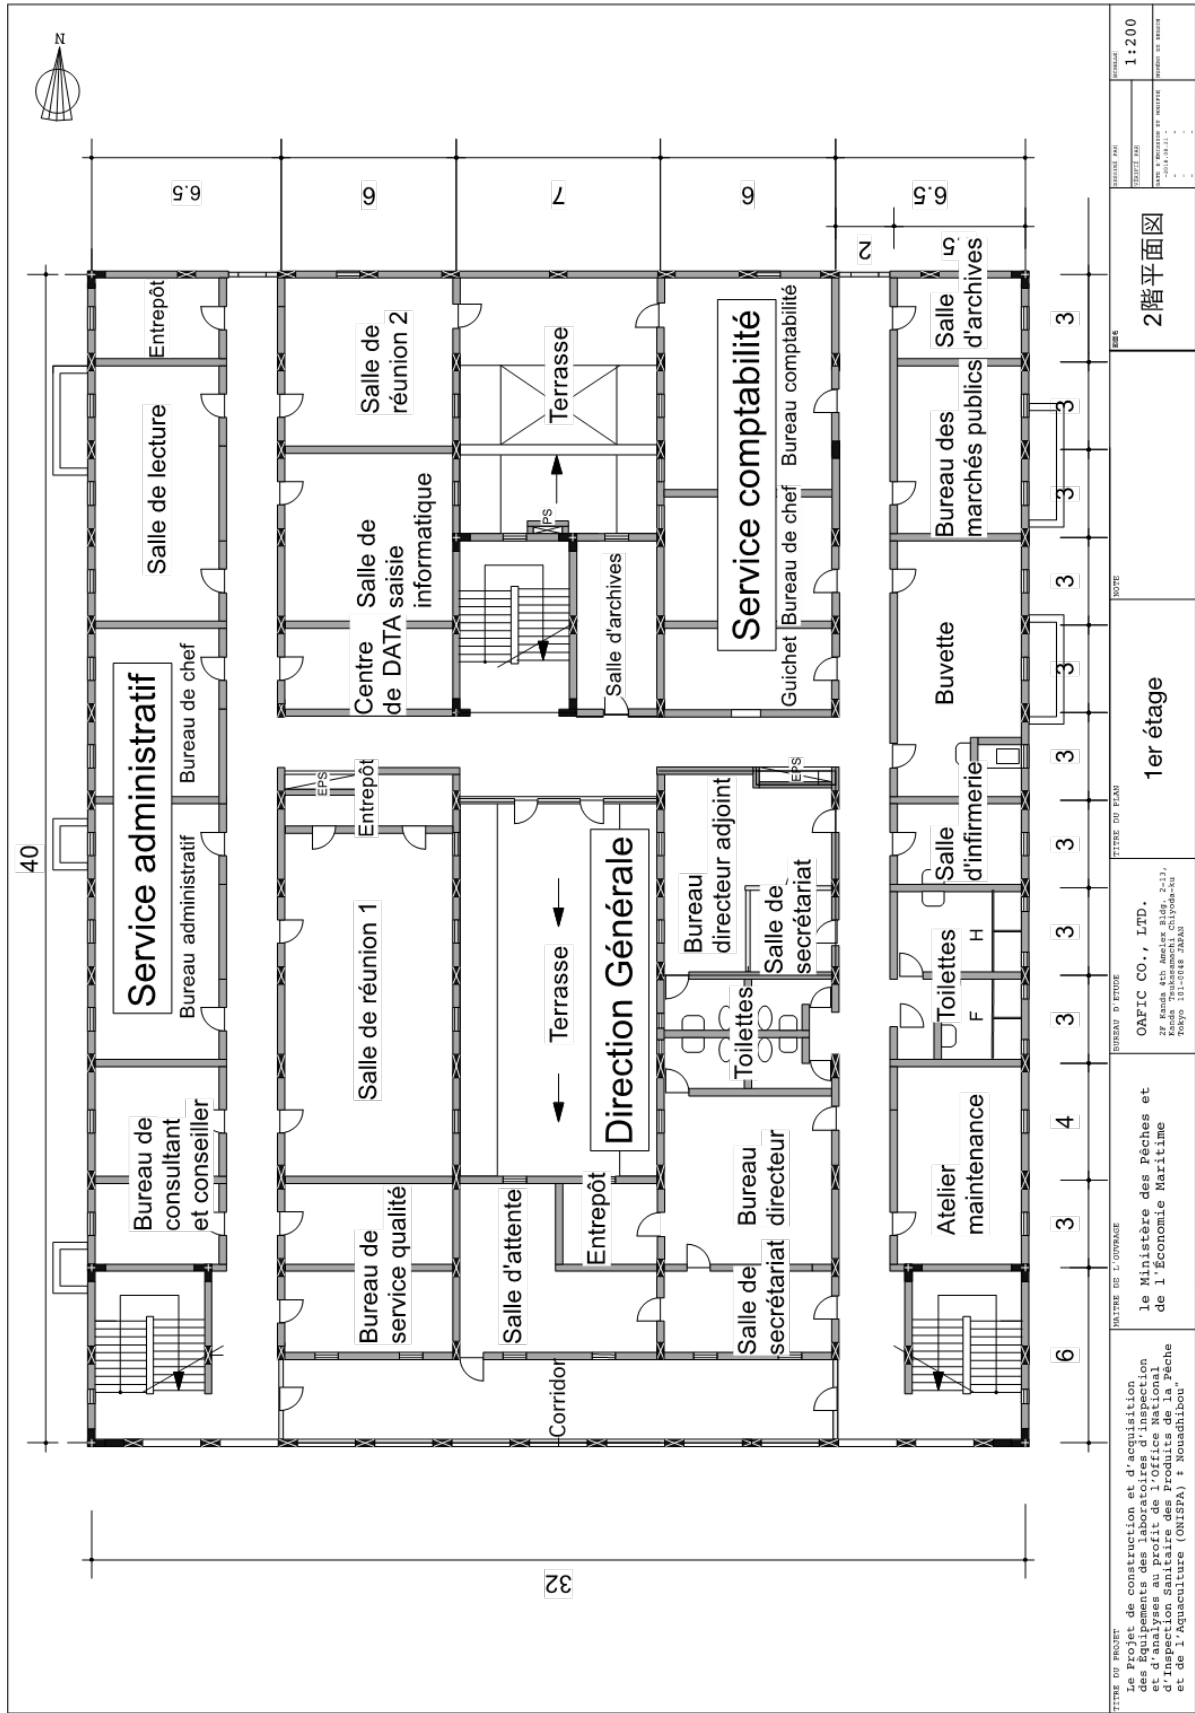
Plan au sol (1<sup>er</sup> étage)
